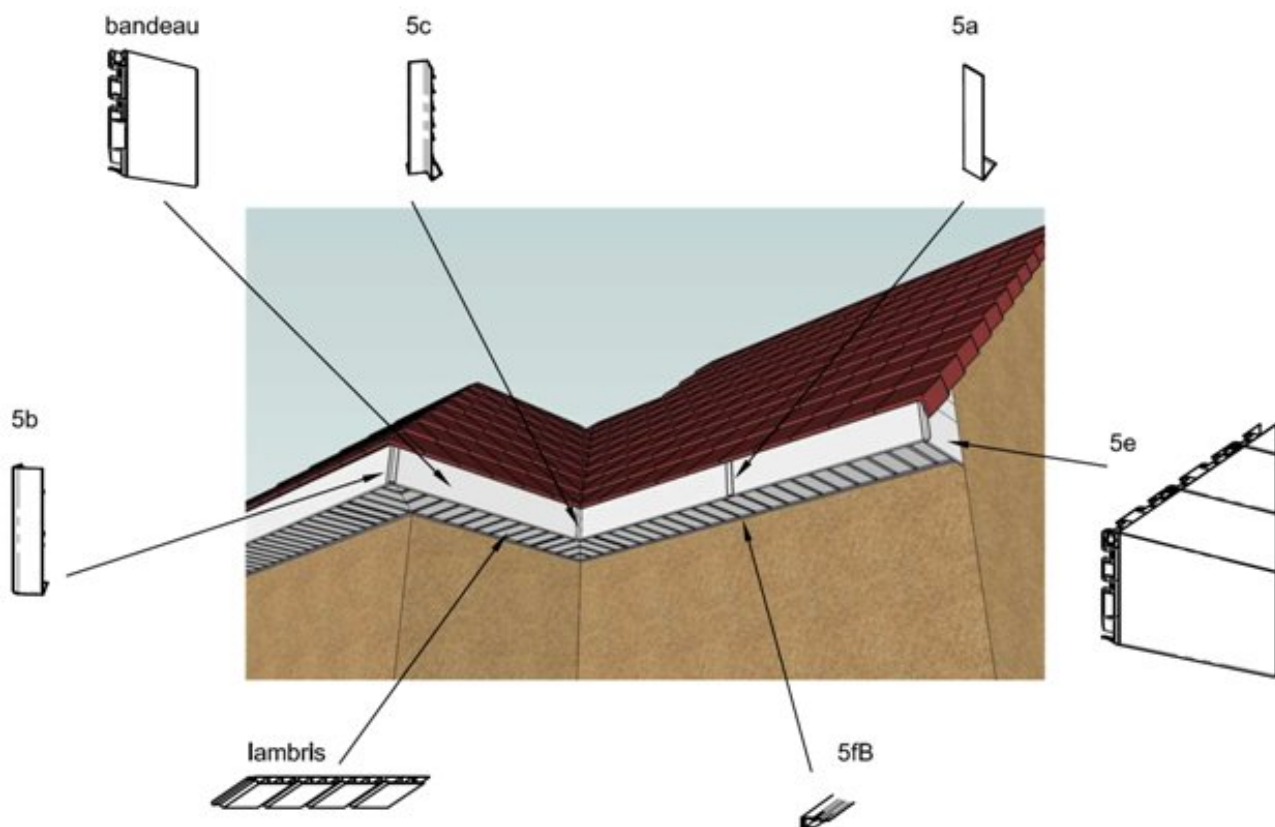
Principe de L'AVANT TOIT PVC – M.E.P.
